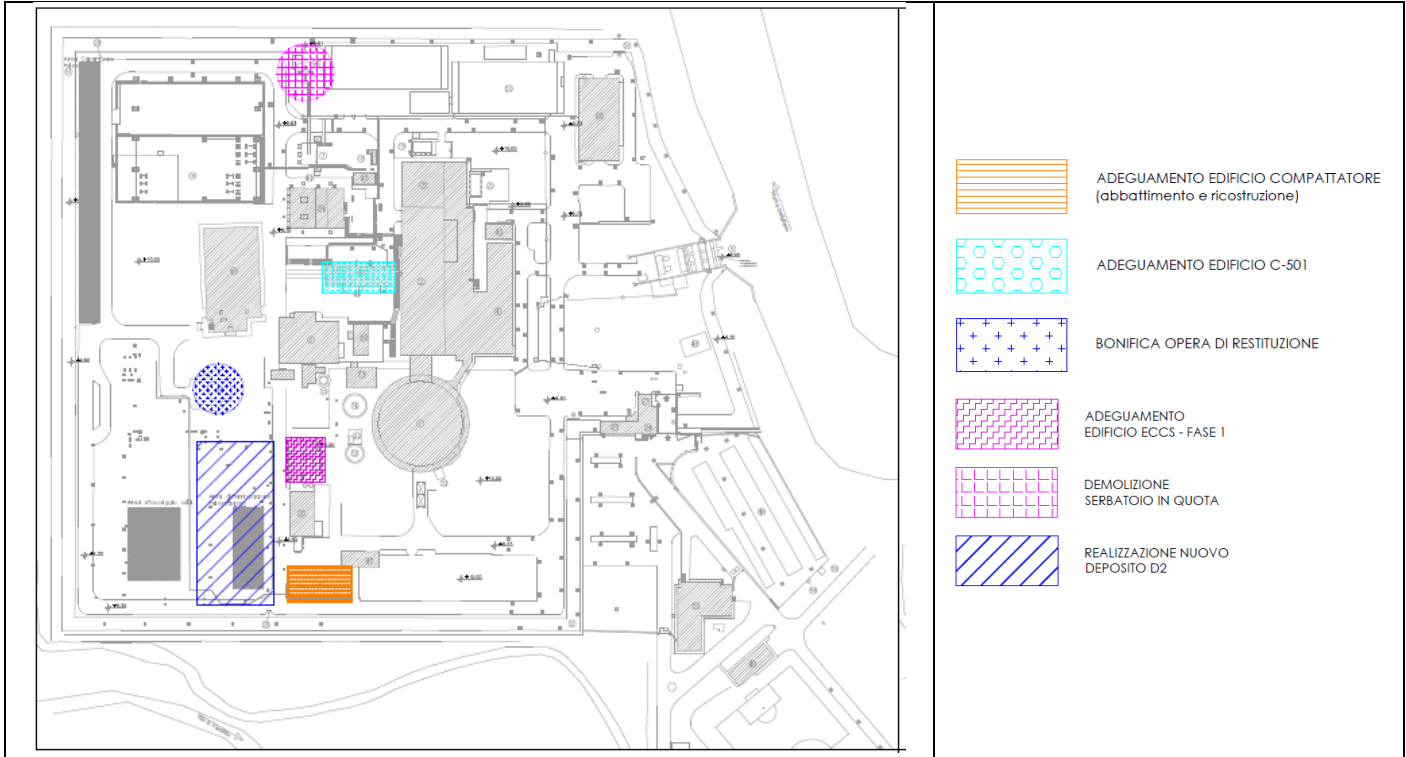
Planimetria delle aree interessate dalle attività potenzialmente significative nel primo semestre 2023
